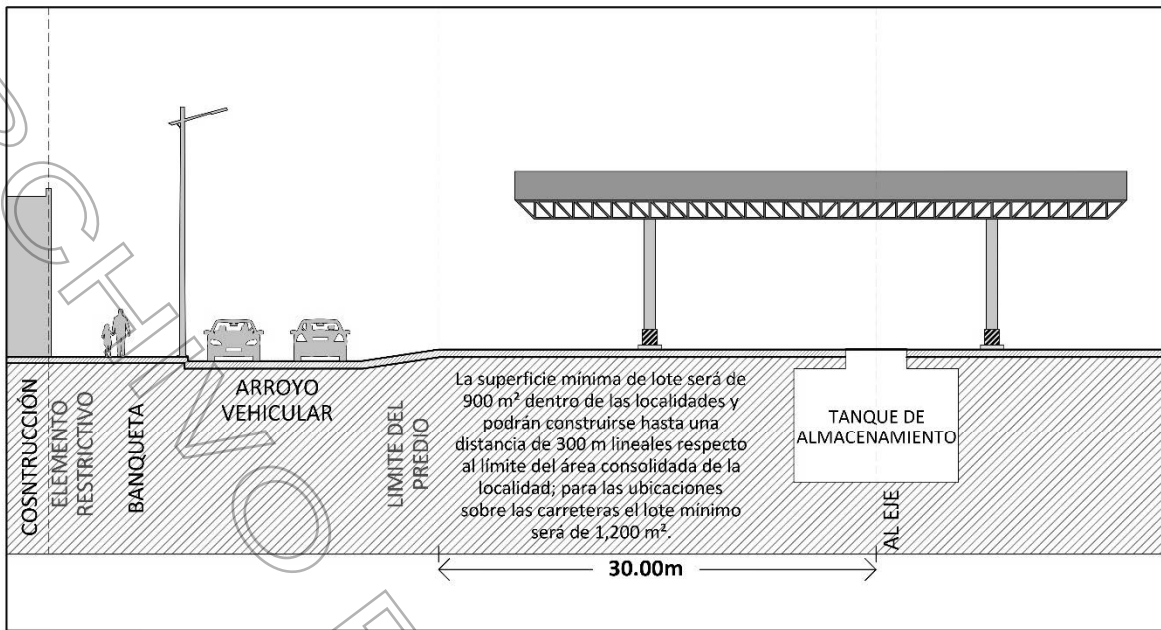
Elementos restrictivos para la construcción de estaciones de servicio y de autoconsumo.
